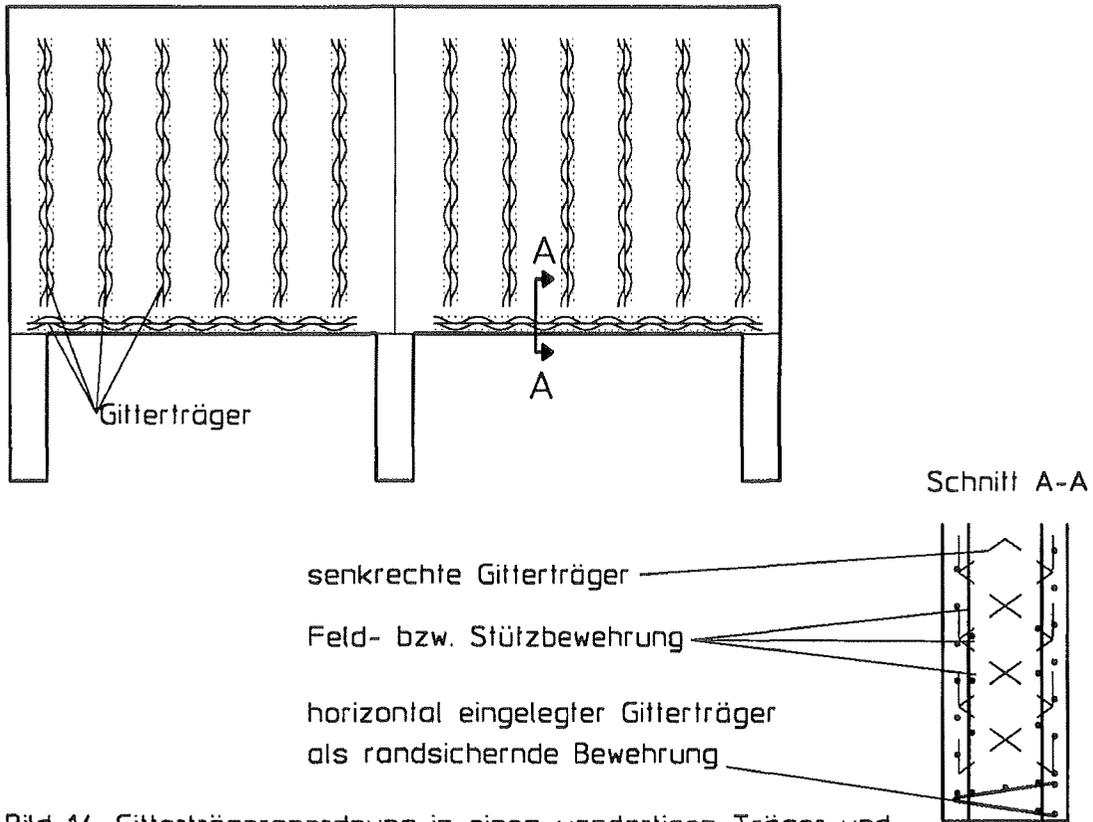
Gitterträgeranordnung in einem wandartigen Träger und Detail der Bewehrungsführung am unteren Wandrand
